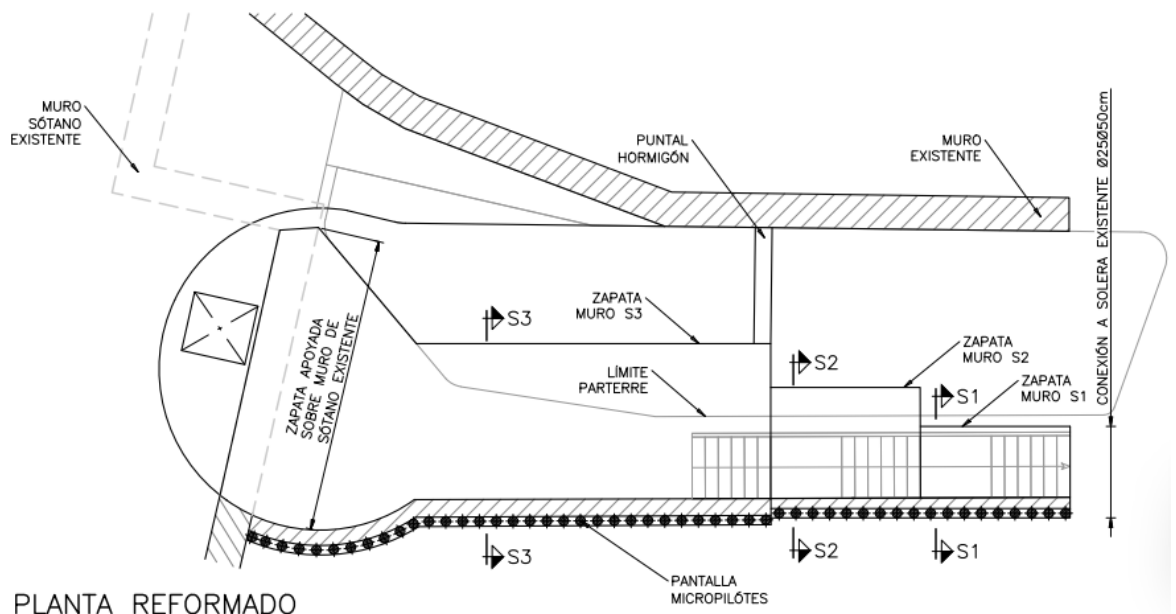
Planta descriptiva de estructuras para la actuación en Calle Carretas en su estado reformado
